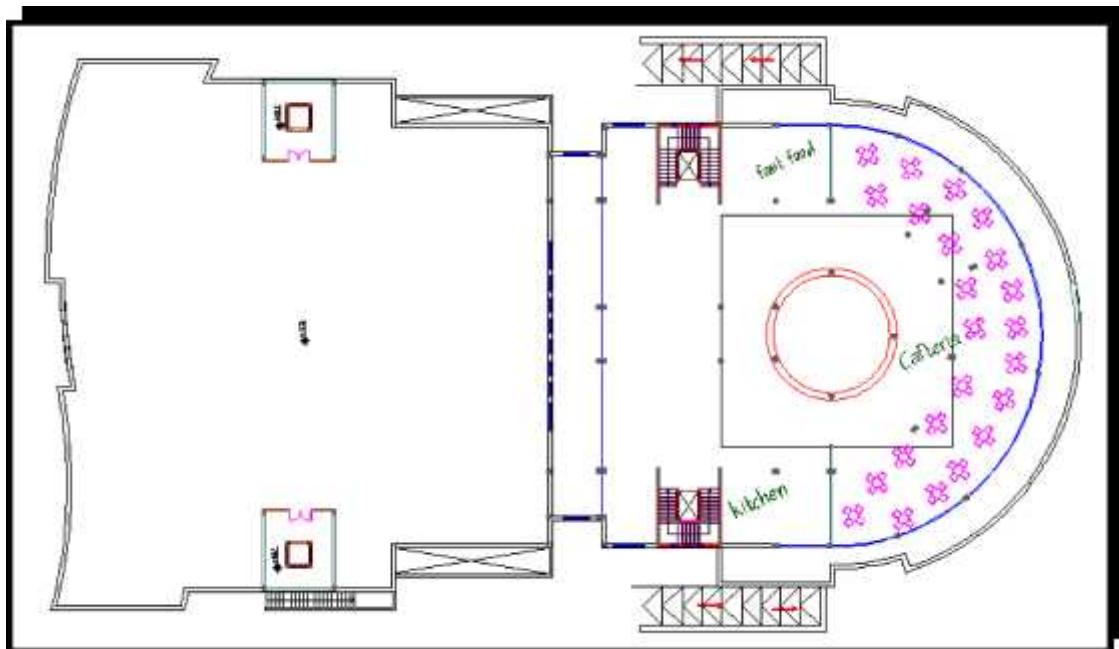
المسقط الأفقي للطابق الثالث
